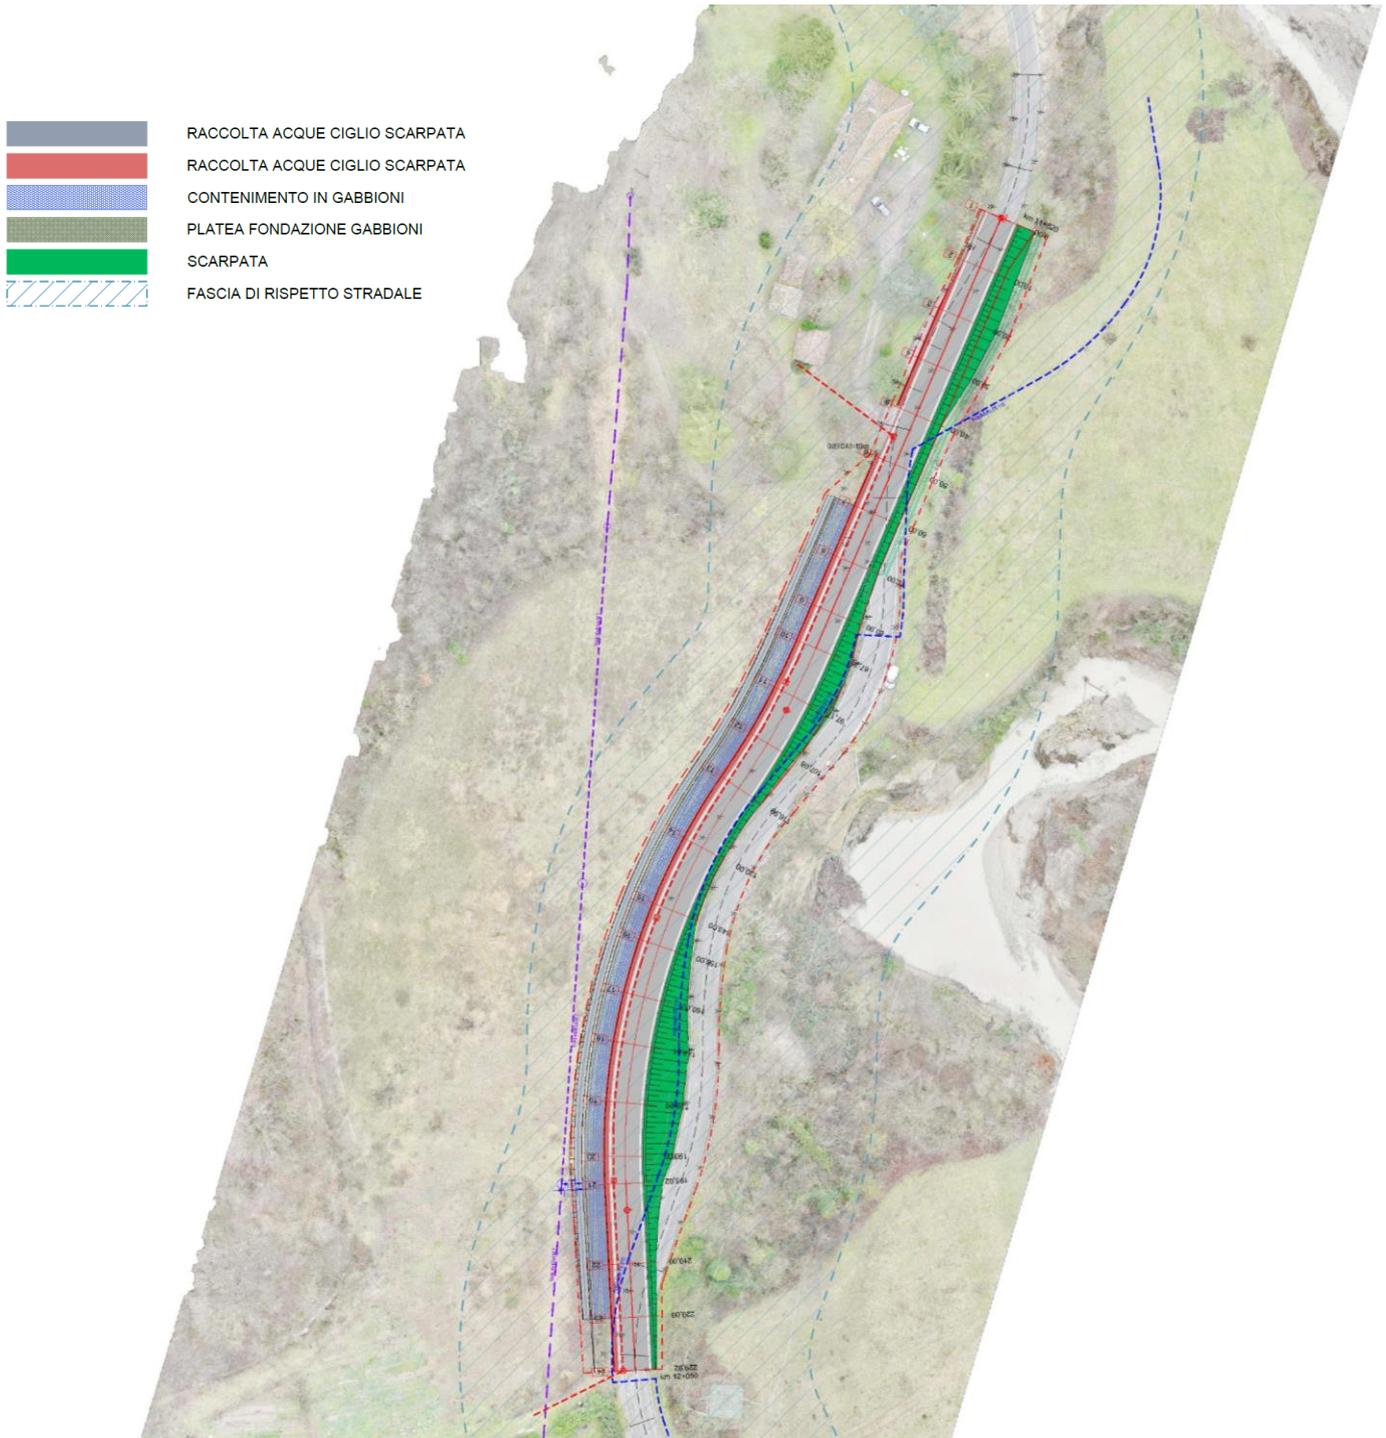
| Planimetria di progetto con indicazione Foto aerea con individuazione delle aree di raccolta acque, del contenimento in gabbioni e della relativa platea di fondazione (elaborato fornito dalla Committenza)
